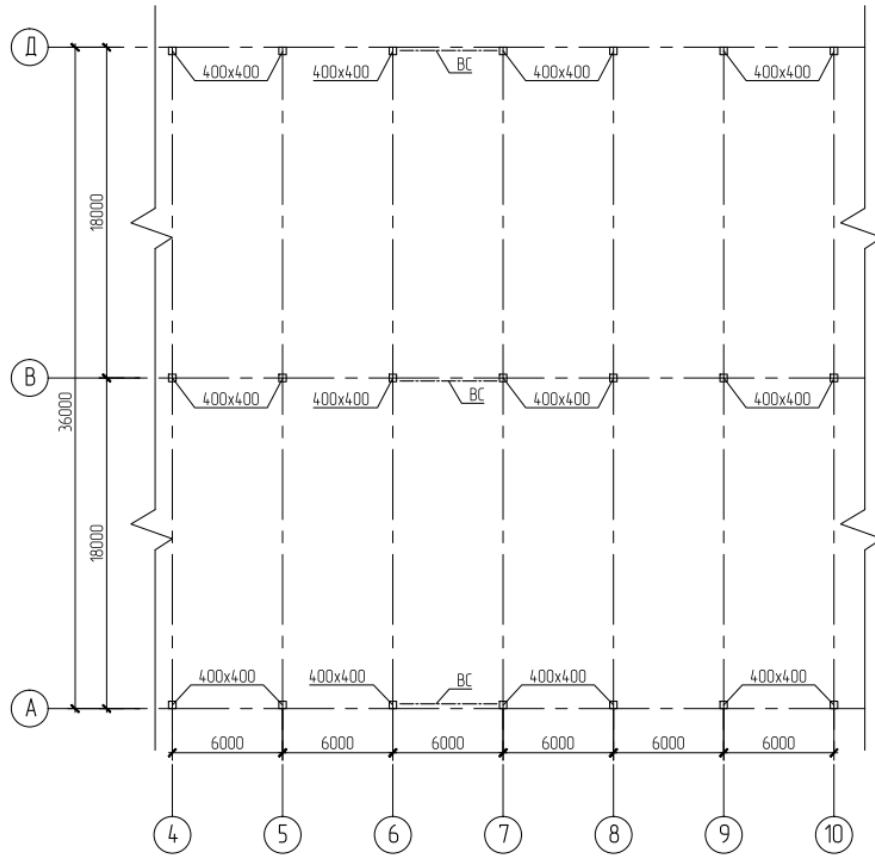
План расположения вертикальных связей и колонн второго этажа в осях А-Д/4-10
